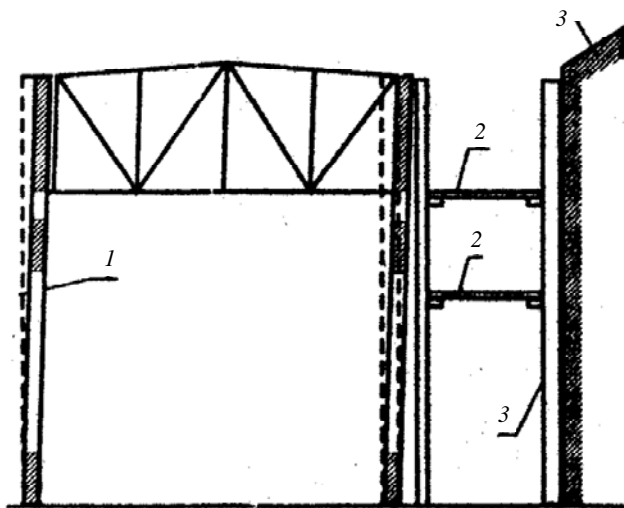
Крепление наклонившейся стены к стенам устойчивых зданий: 1 – деформированное здание; 2 – распорка; 3 – устойчивое сооружение
